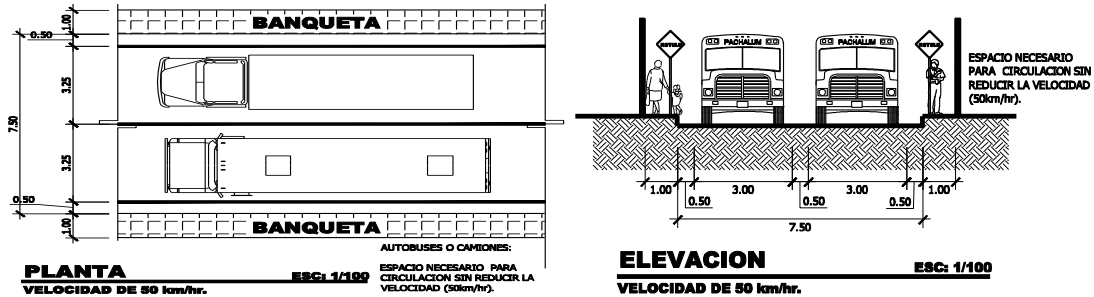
Ancho de calle primaria al terreno. Fuentes: Elaboración propia, del trabajo de campo
